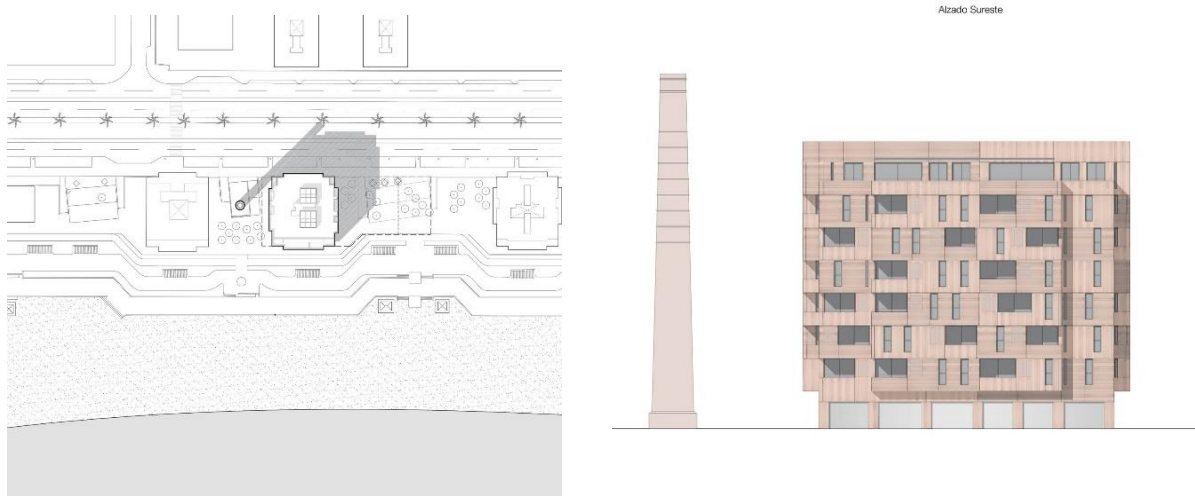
y 45. Plano de situación y Alzado suroeste del edificio. Fuente: Tectónica, Edificio de viviendas en Málaga de Muñoz Miranda, <https://tectonica.archi/projects/73-viviendas-para-alquiler-de-munoz-miranda/>
